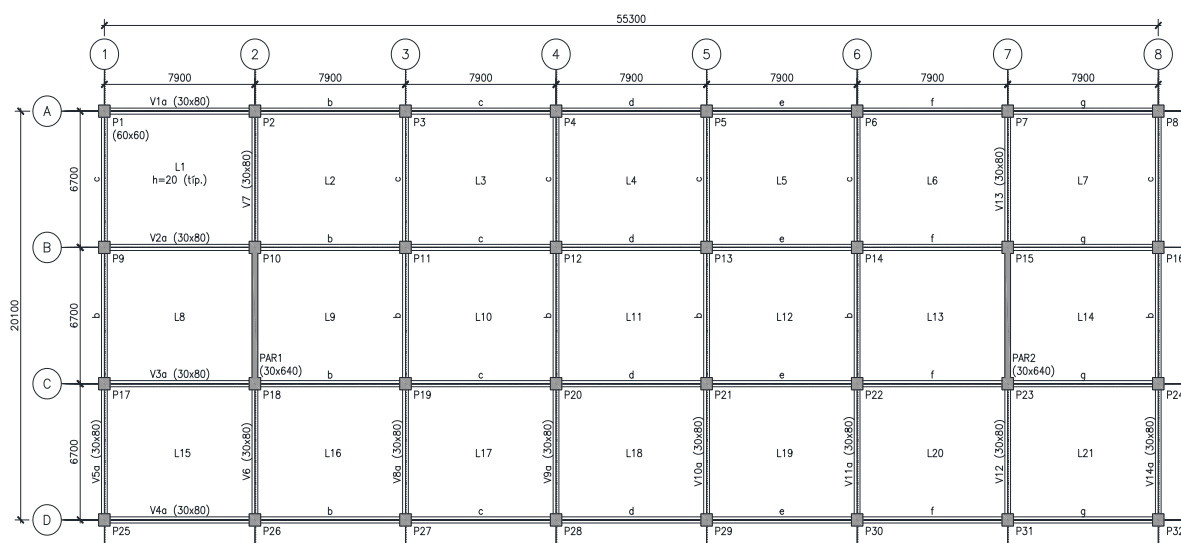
Edifício Padrão - Planta do pavimento tipo (dimensões em milímetros)
